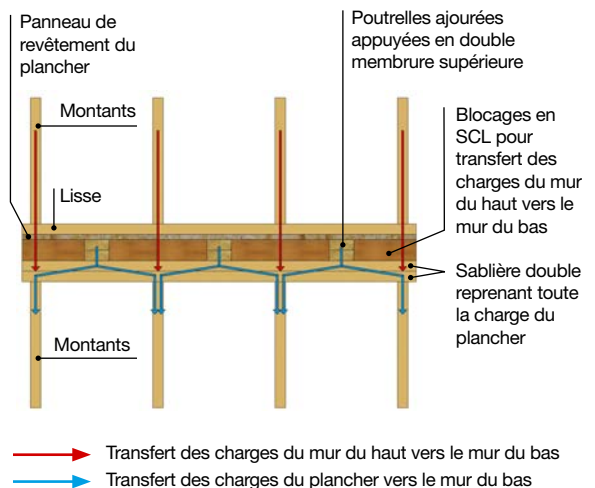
• Montants alignés d'un étage à l'autre et poutrelles non alignées
